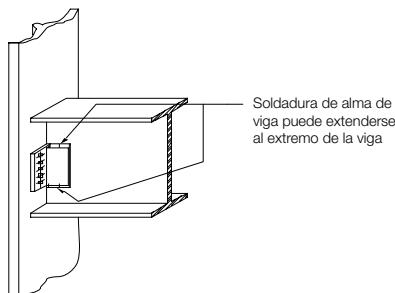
Detalles de soldadura de filete en conexión con doble ángulo.
